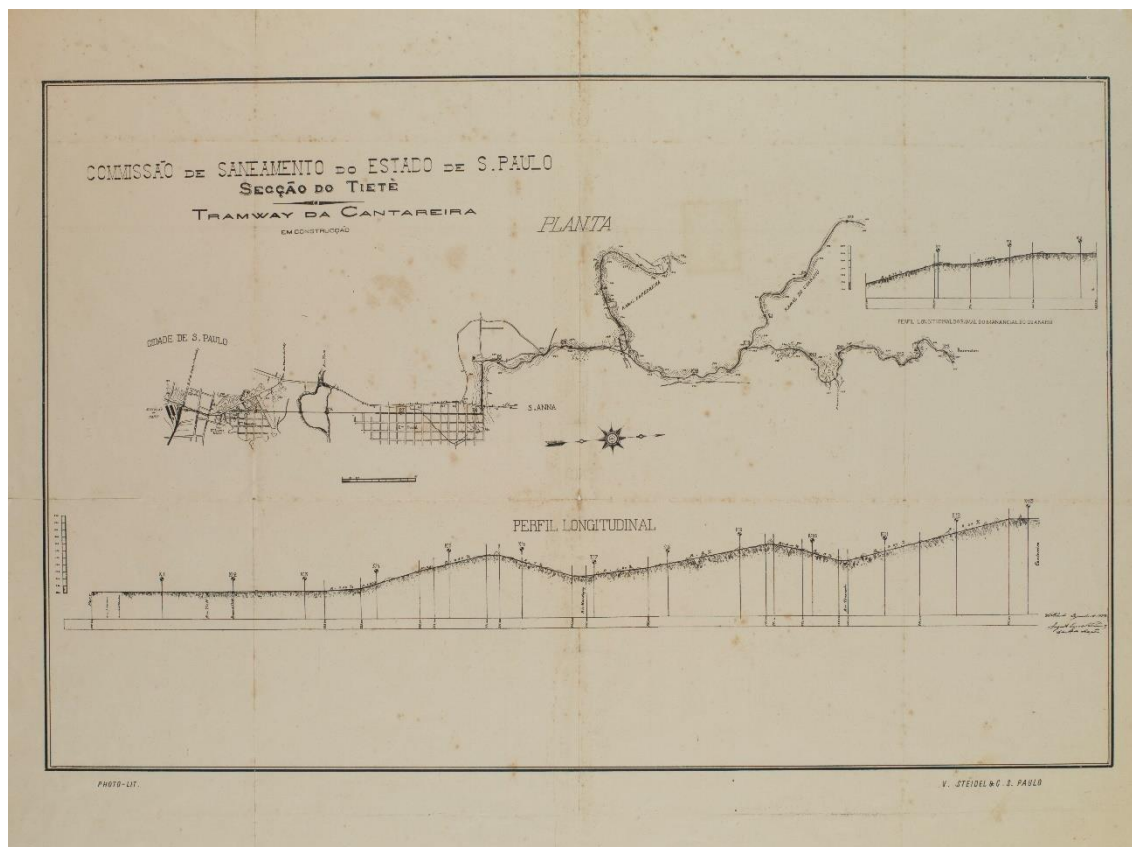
Planta da Comissão de Saneamento do Estado de S. Paulo, seção Tietê, *Tramway* da Cantareira em Construção. 1893. Arquivo do Museu Paulista da USP.
